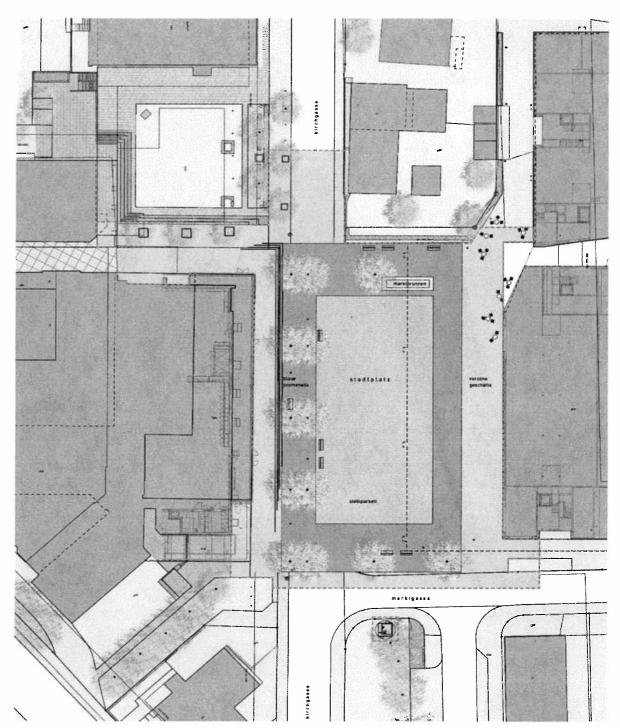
Situationsplan des Stadtplatzes: Marktbrunnen vor dem Bauernhaus Kirchgasse 12 (oben), Toilettenanlage an der Marktgasse (unten). Dank dem Standort ausserhalb der offenen Platzfläche ist das Toilettengebäude bei Veranstaltungen nicht im Weg und dennoch gut erreichbar. Mit einer weiteren Etappe (Stadtplatz Süd) ist der Standort kompatibel.
